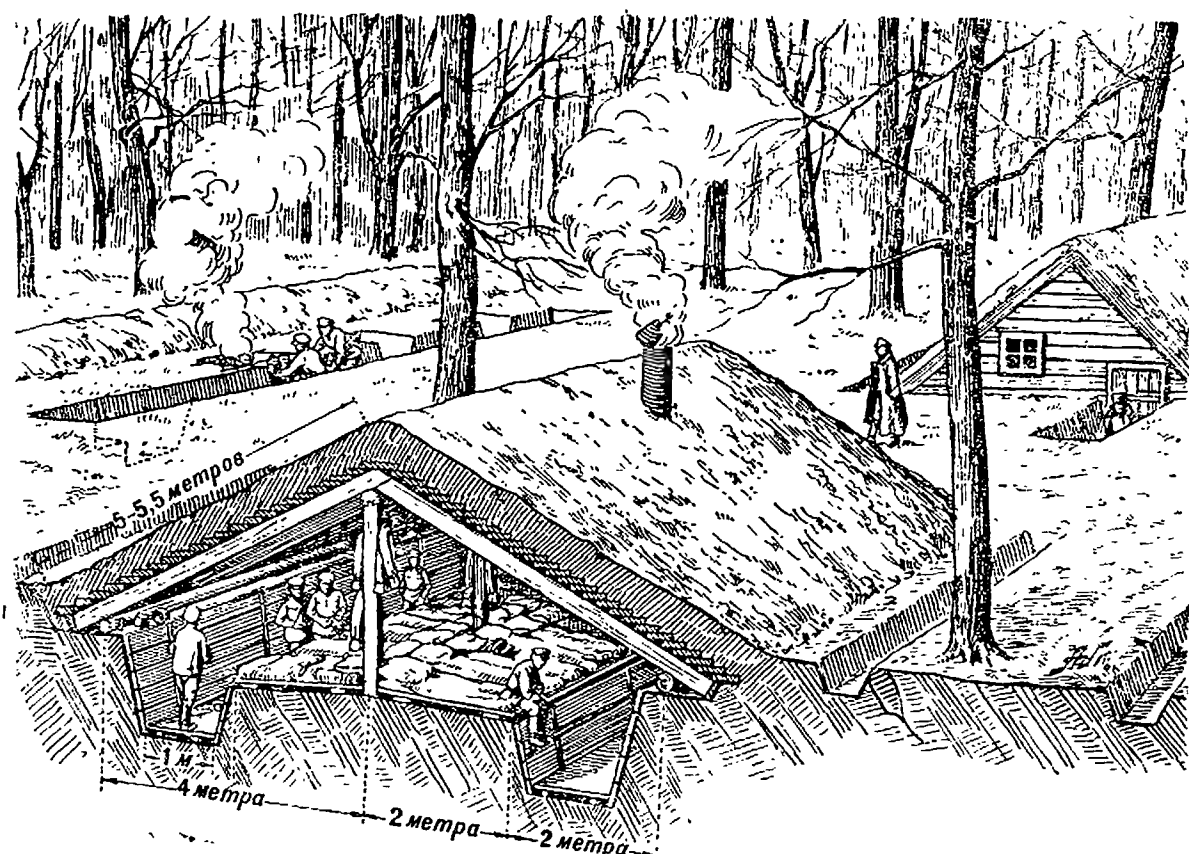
Устройство землянок и очага для варки пищи в котлах.
